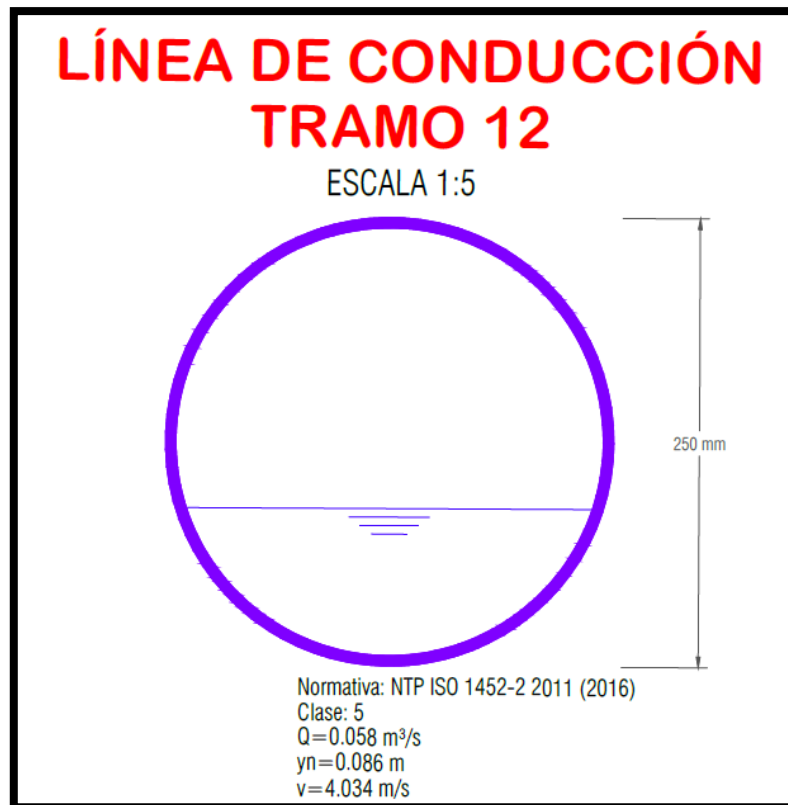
Sección típica de la tubería de PVC-U 250 mm, Tramo 12
